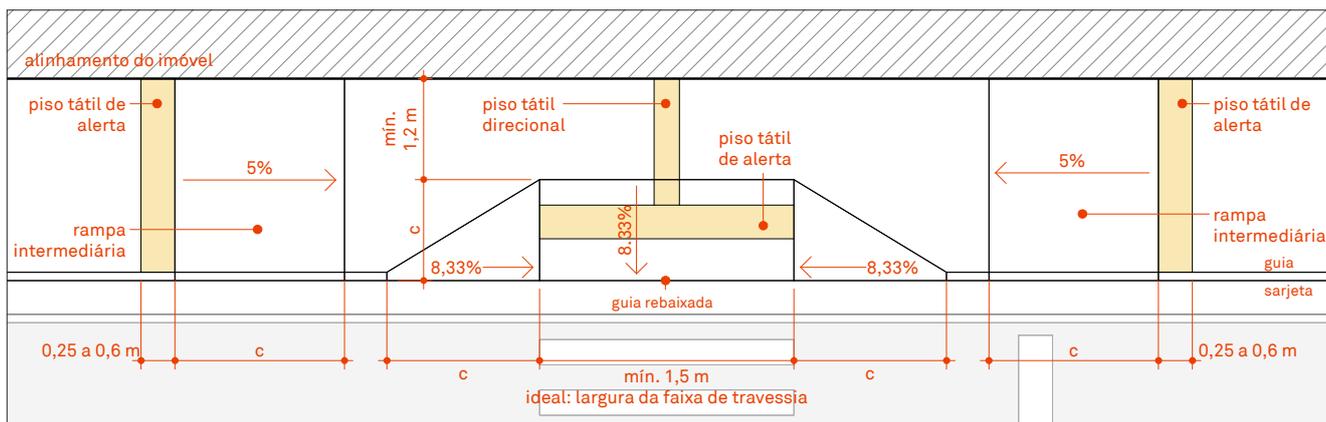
Rebaixamento de calçada tipo II, com aplicação de piso tátil da – ver Figura 38.
